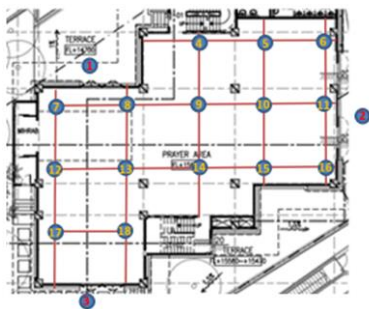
Denah Lantai 2, 3, dan 4 Masjid WTC Jendral Sudirman
